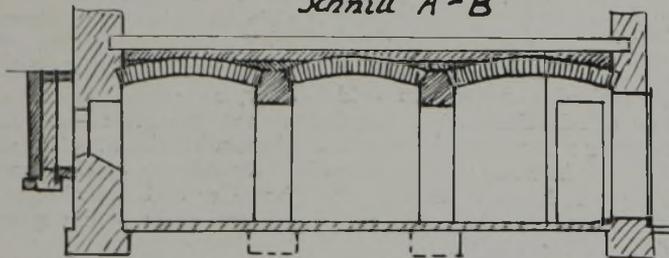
und 2. Dreigeschossiges Haus, 15 Personen. Holzbalkendecke ersetzt durch Kappengewölbe zwischen Gurtbögen.
